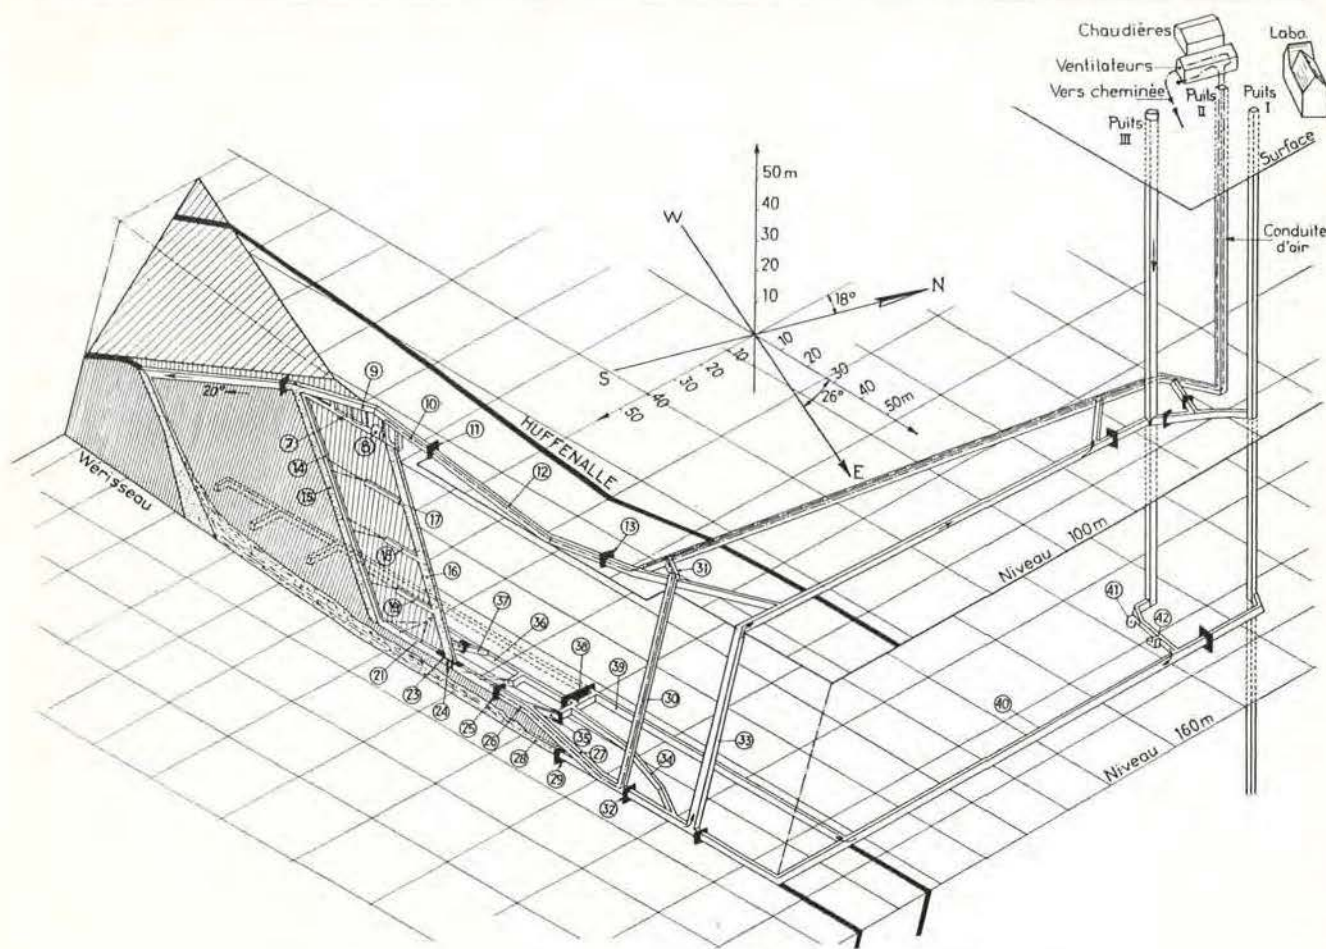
Vue perspective du chantier n° 2. — En pointillé : galerie d'observation de l'essai n° 1.
